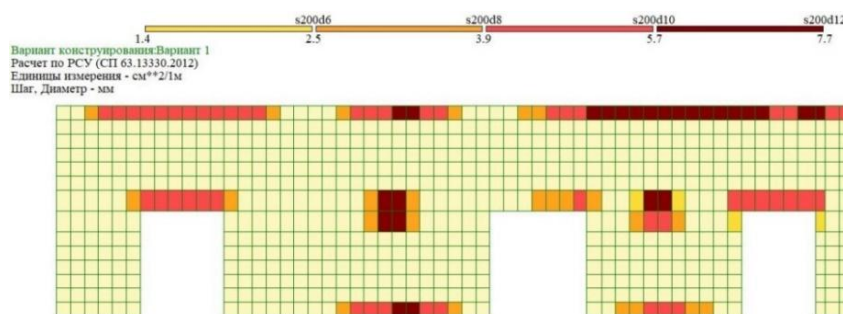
Подбор верхней поперечной арматуры плиты
